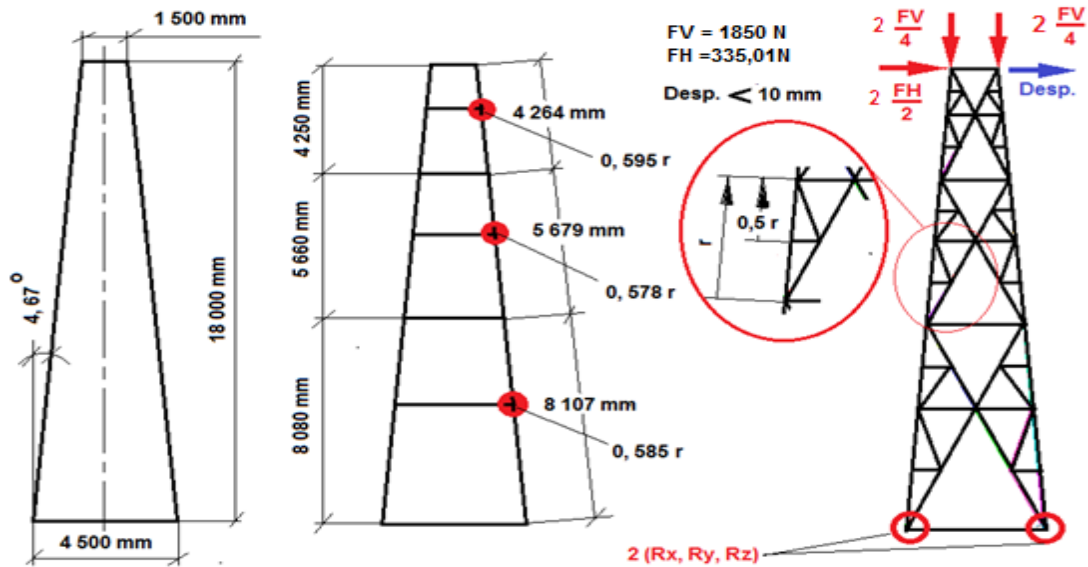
Proporciones de la armadura, aplicación de las fuerzas y reacciones en los apoyos.
